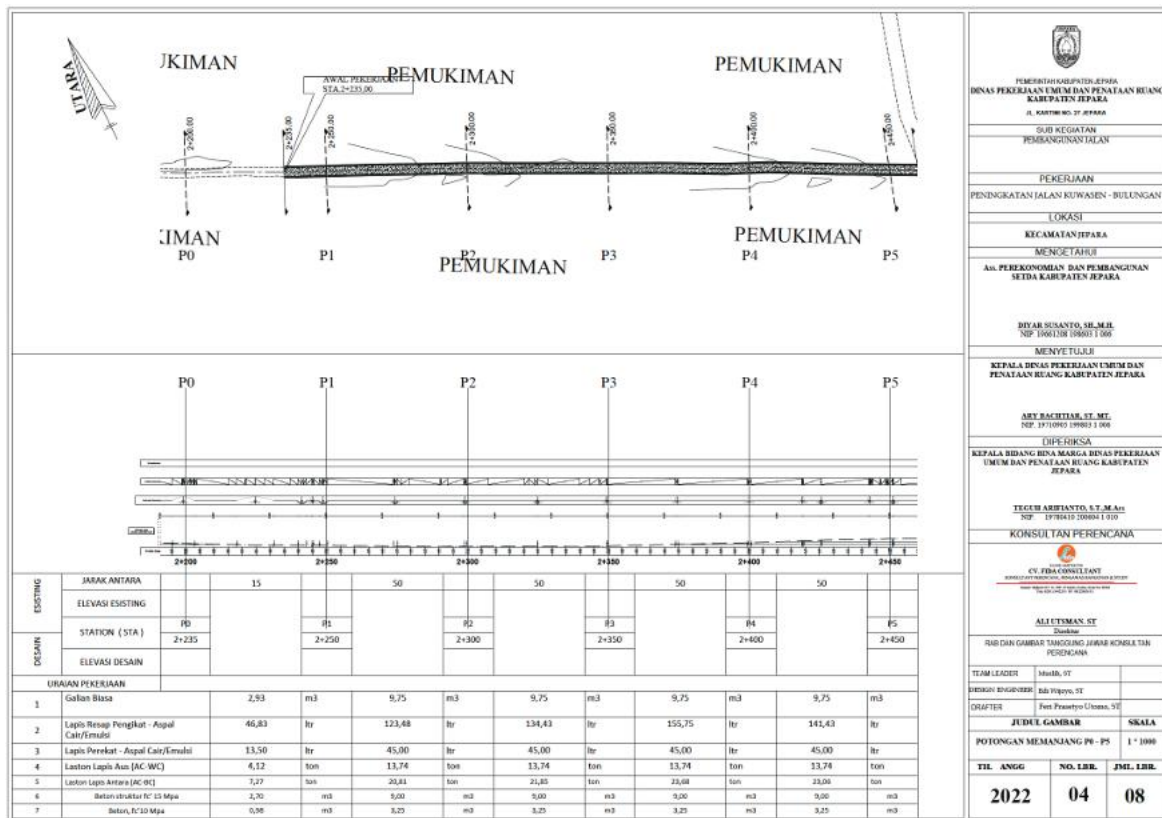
Denah Situasi Pekerjaan Jalan
